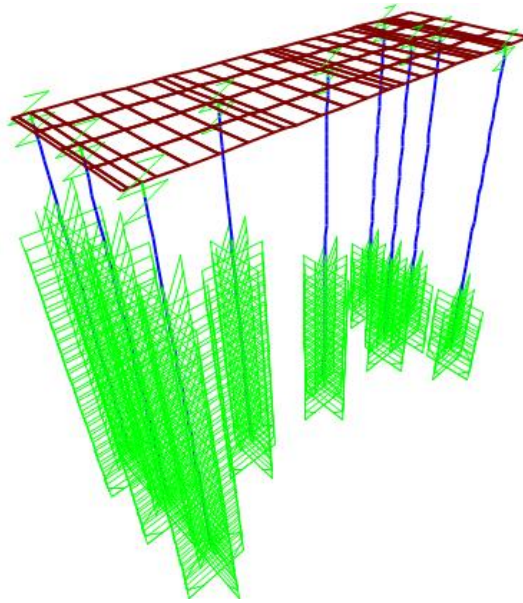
Modelo estrutural do cais para a análise de Pushover – vista 3D.
